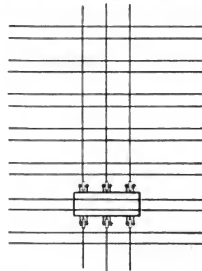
Schiebebühne, deren Führung durch symmetrische Mittelräder bewirkt wird.
